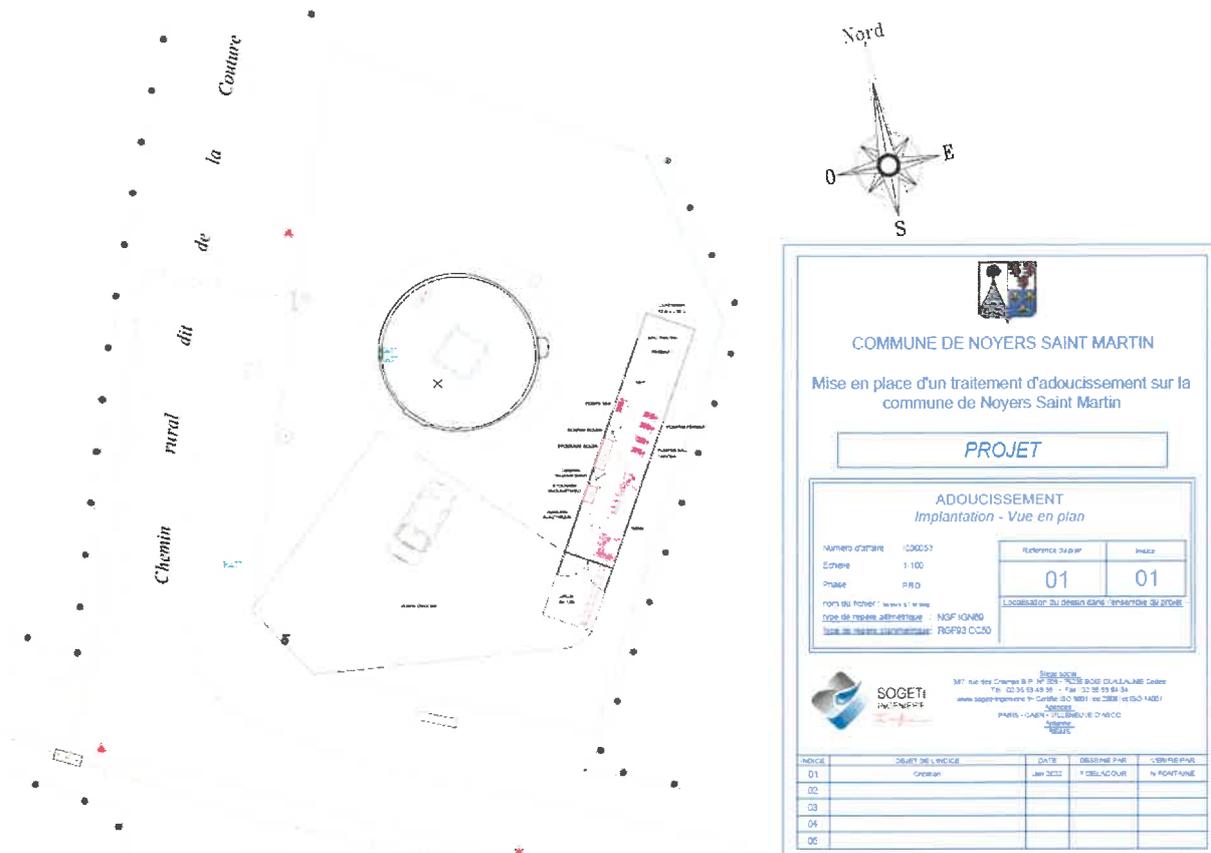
Plan masse de l'unité de traitement sur la parcelle du captage existant
